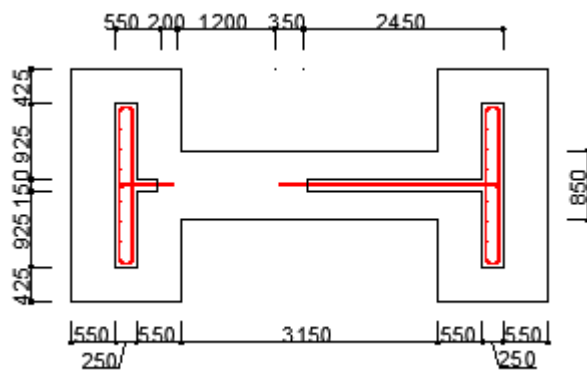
試験体配筋図 (開口設置前) (単位: mm)
